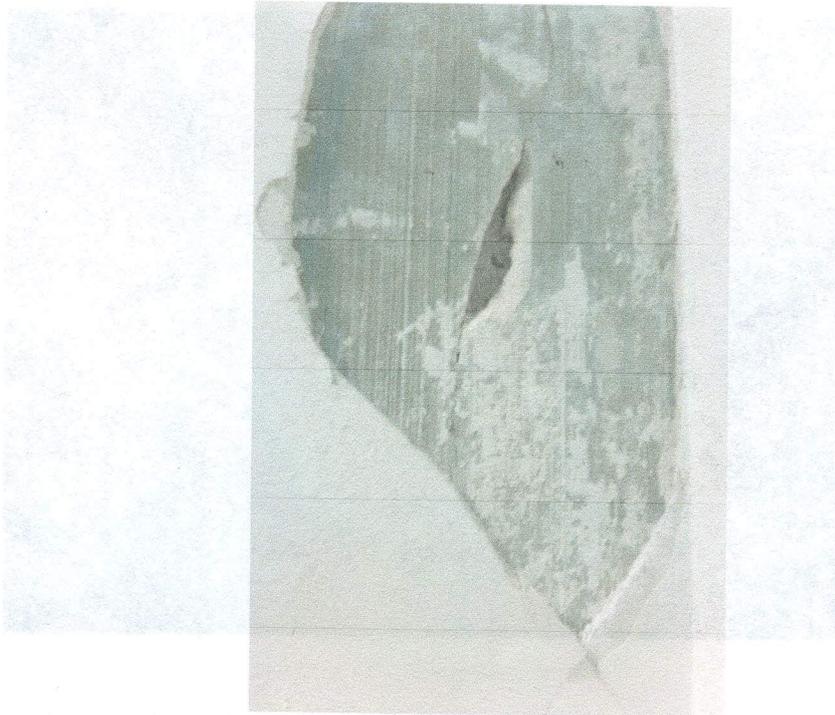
Grieta y desprendimiento de acabado en columna en planta baja. La columna no está dañada ya que el acabado se encuentra desprendido de un segundo acabado el cual solo esta agrietado.
